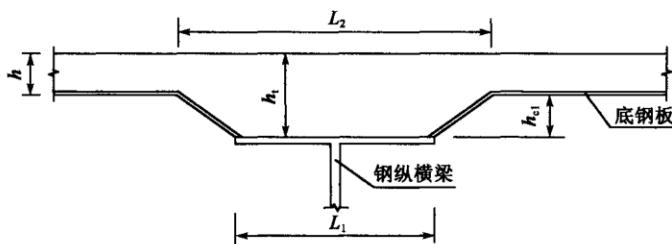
钢-混凝土组合桥面板承托构造示意图
